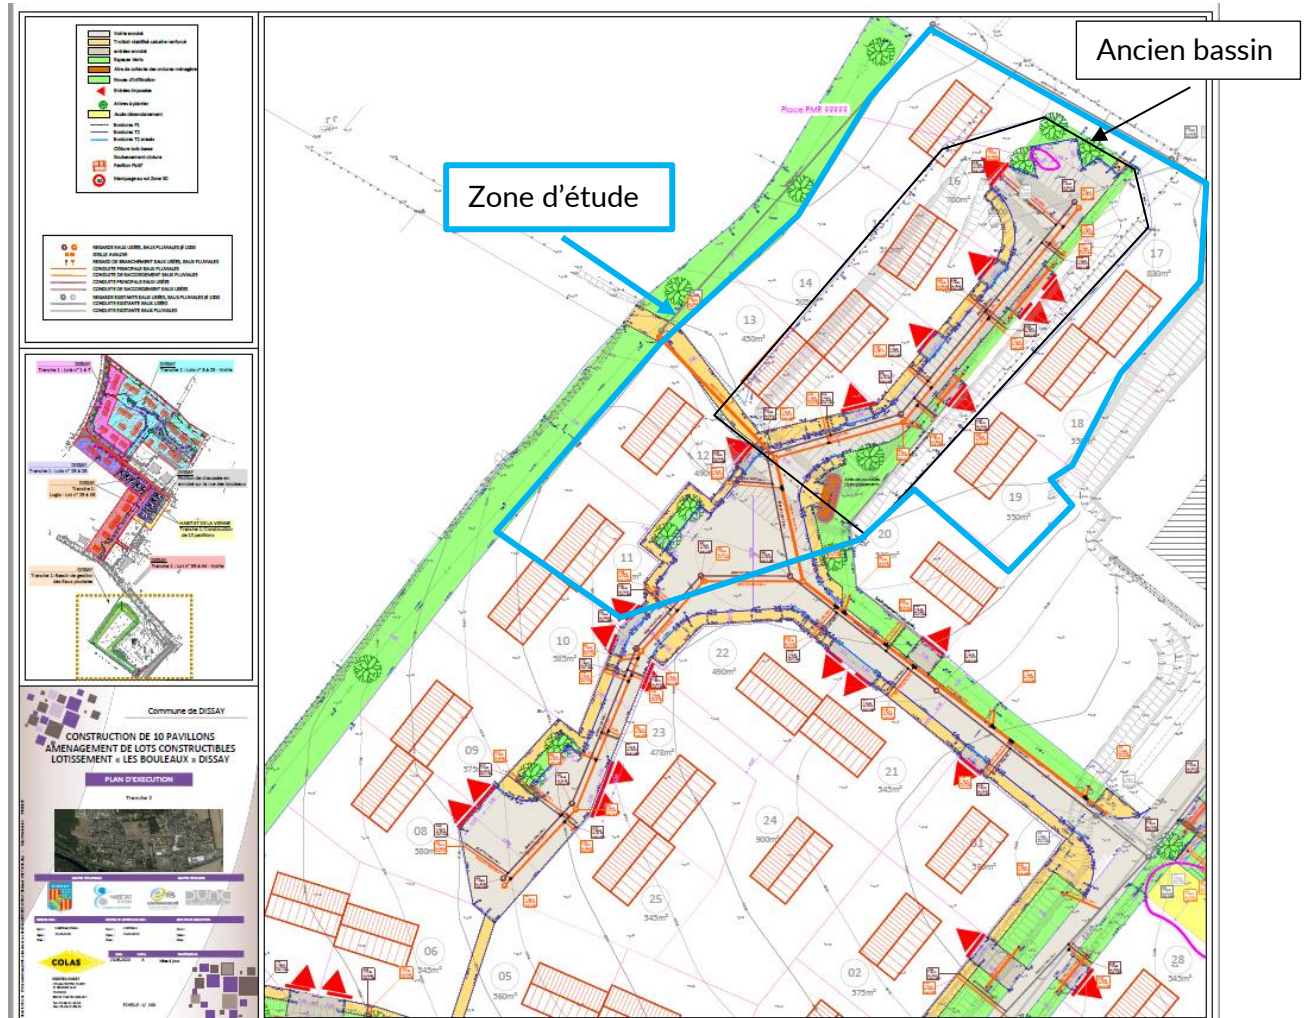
Plan de masse du projet (source : LE MANS METROPOLE)
